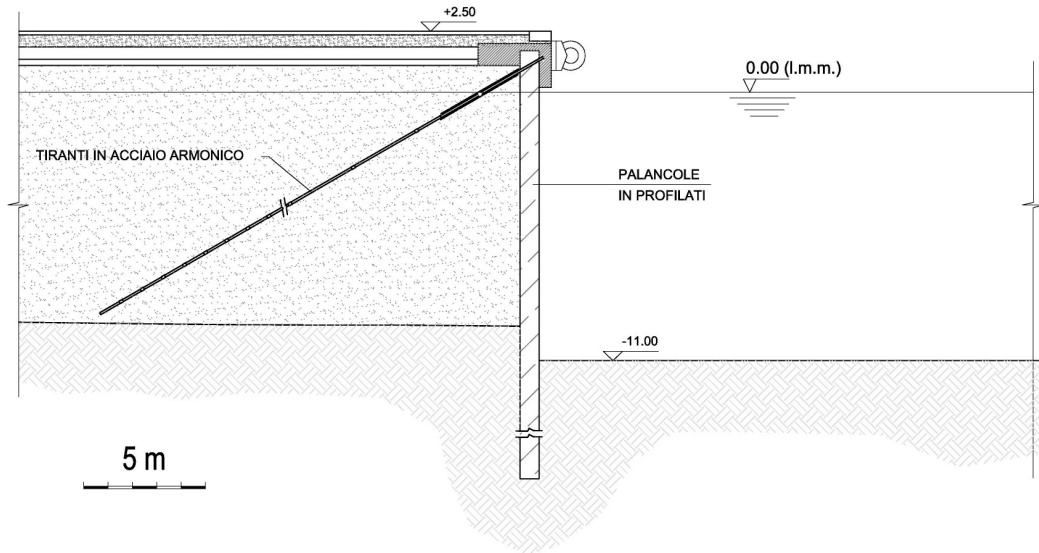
Porto di Messina. Sezione tipica dell'avanzamento del molo Norimberga
